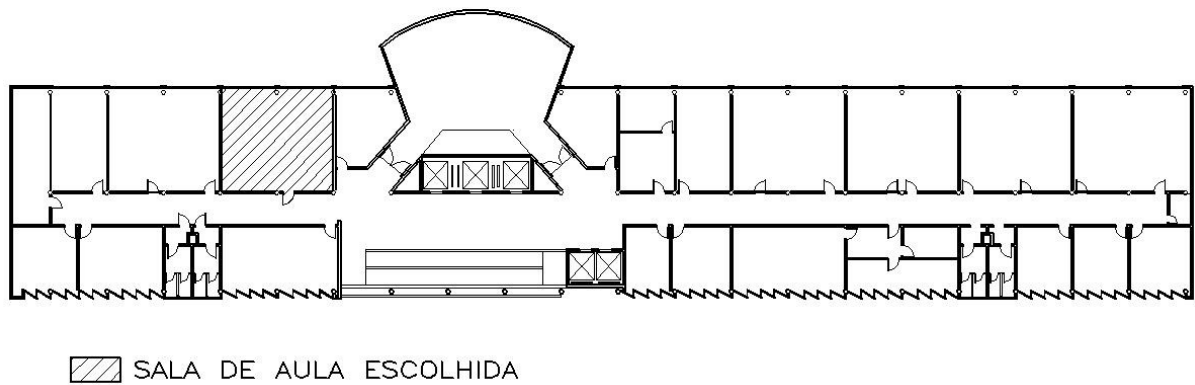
Planta do oitavo pavimento do edifício Dom Pedro I, com destaque para a sala de aula escolhida para análise e detalhamento
